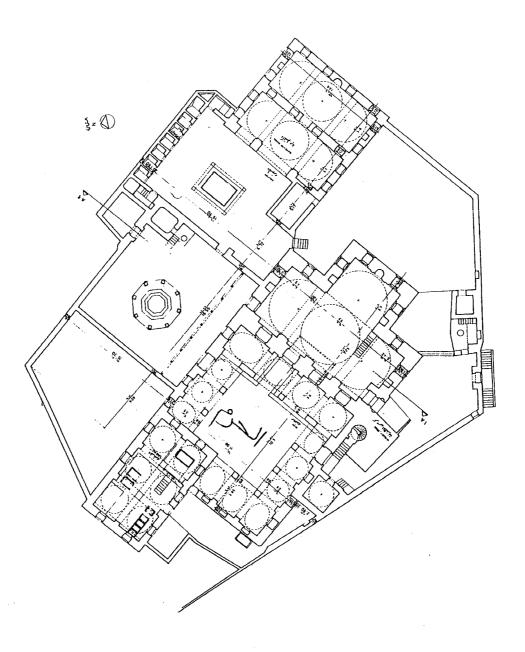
مكرر) مسقط أفقي لخانقاة السلطان برسباي ضمن مجمعه بقرافة صحراء المماليك بالقاهرة .
